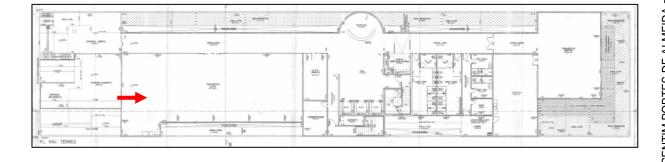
Sala 1 do pavimento térreo.
